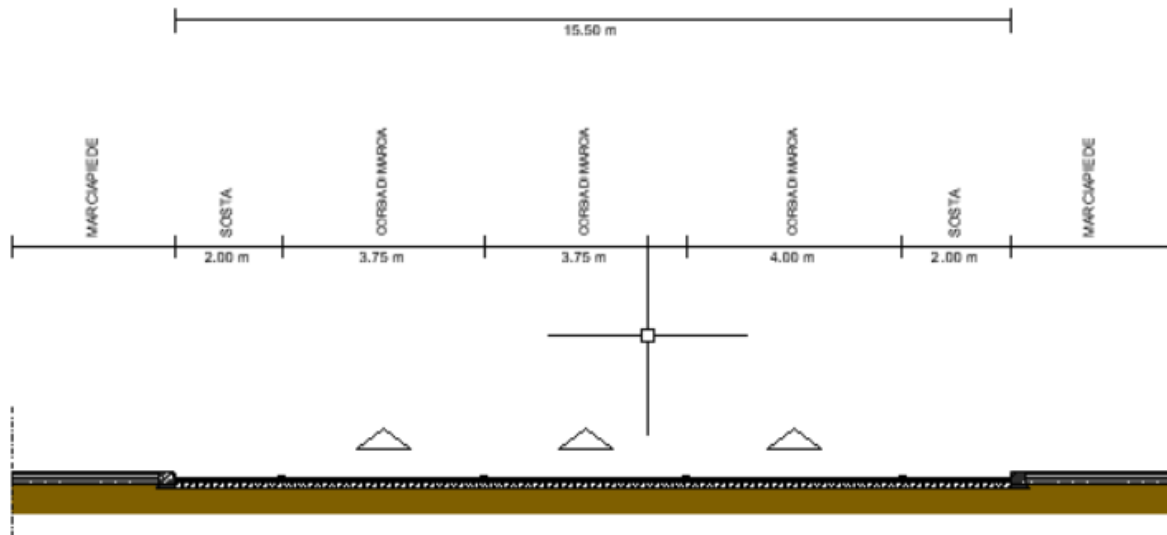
via Giulio Cesare - sezione trasversale esistente.
